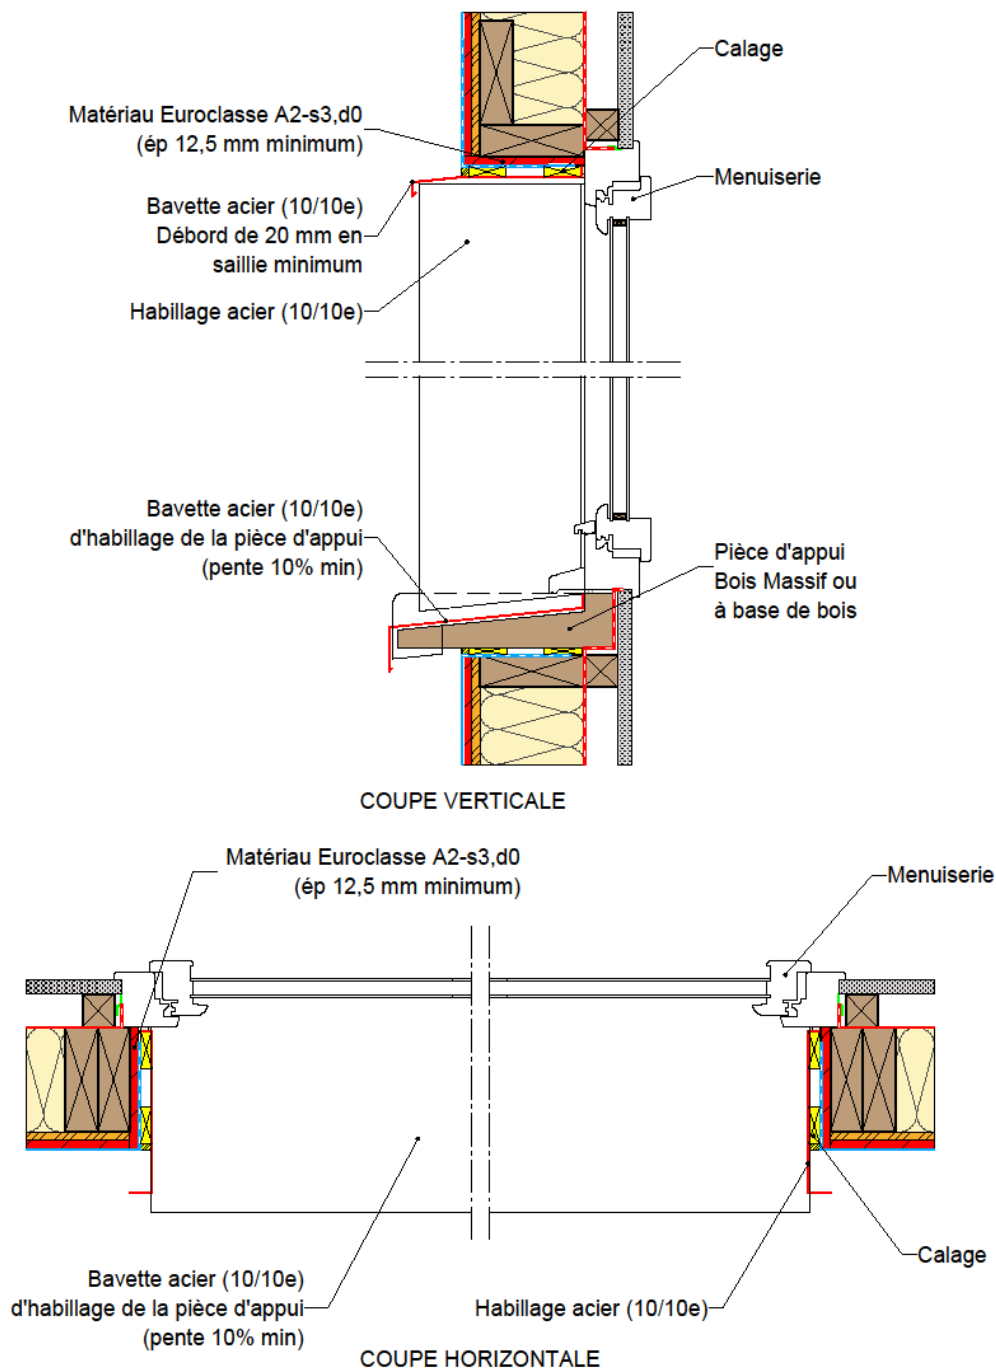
Coupe verticale et horizontale de l'habillage des baies
